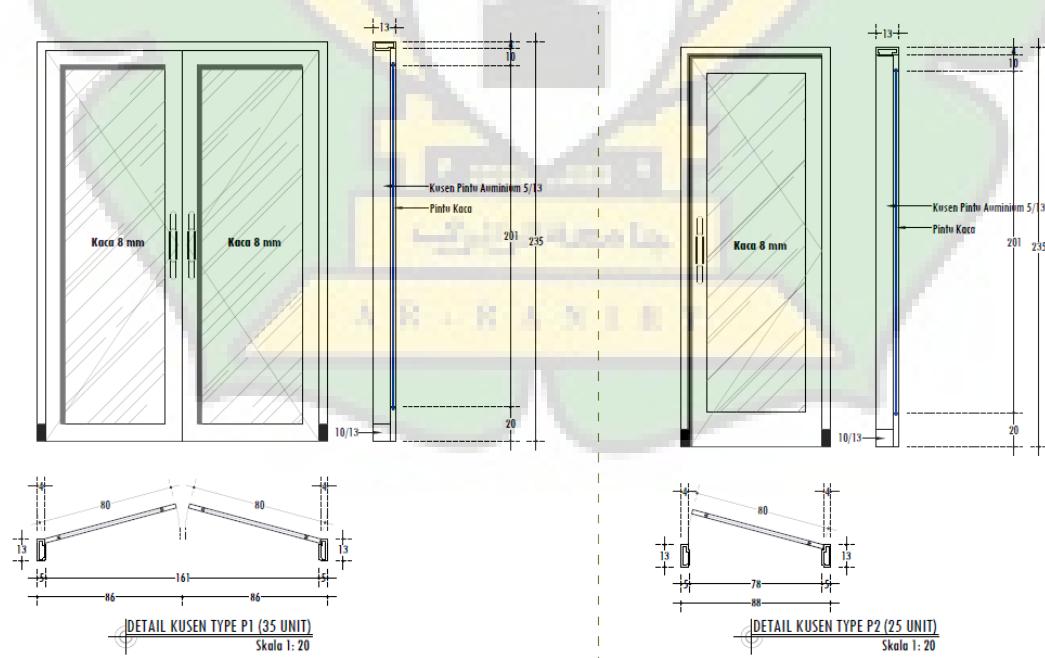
16 Denah Rencana Kusen lantai 3
